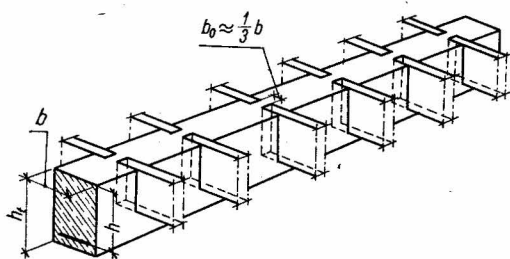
Poutre-maîtresse en béton armé avec les nervures préfabriquées
